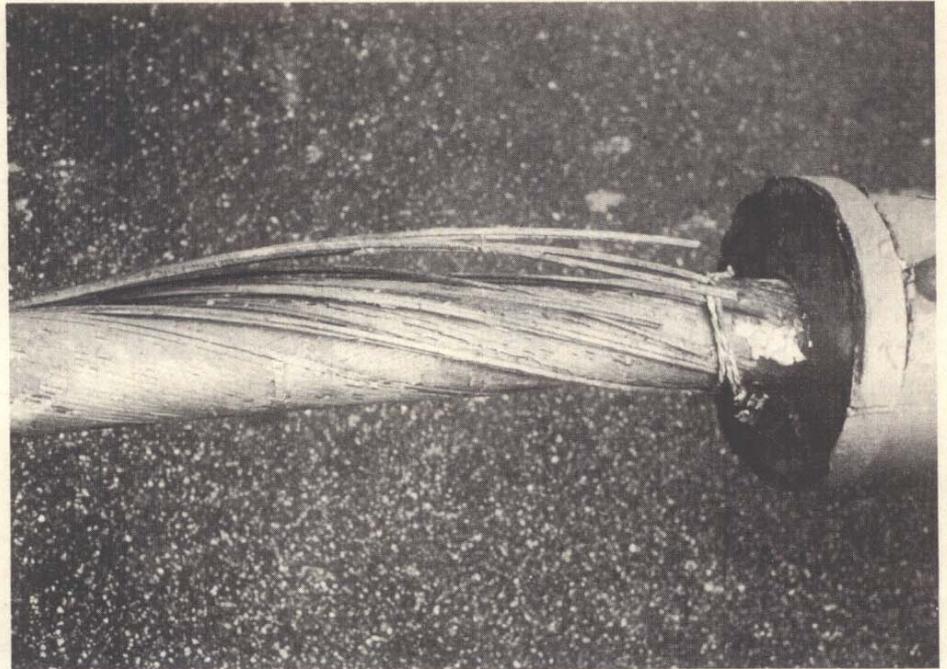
Puente Ulmenstraße. Tensado de los tirantes. Según (3).
